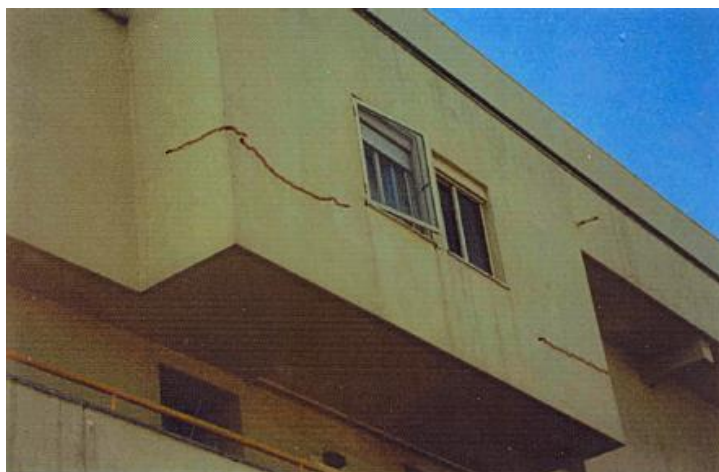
Exemplo real de fissuras em alvenarias de fachada devido à deformação da laje em consola
